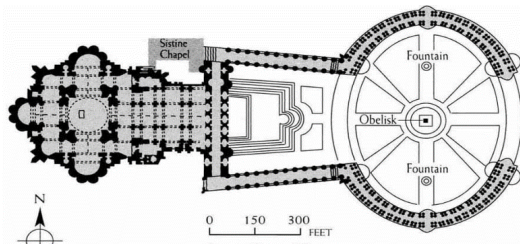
Planta Arquitectónica y distribución, Plaza de San Pedro [10].
